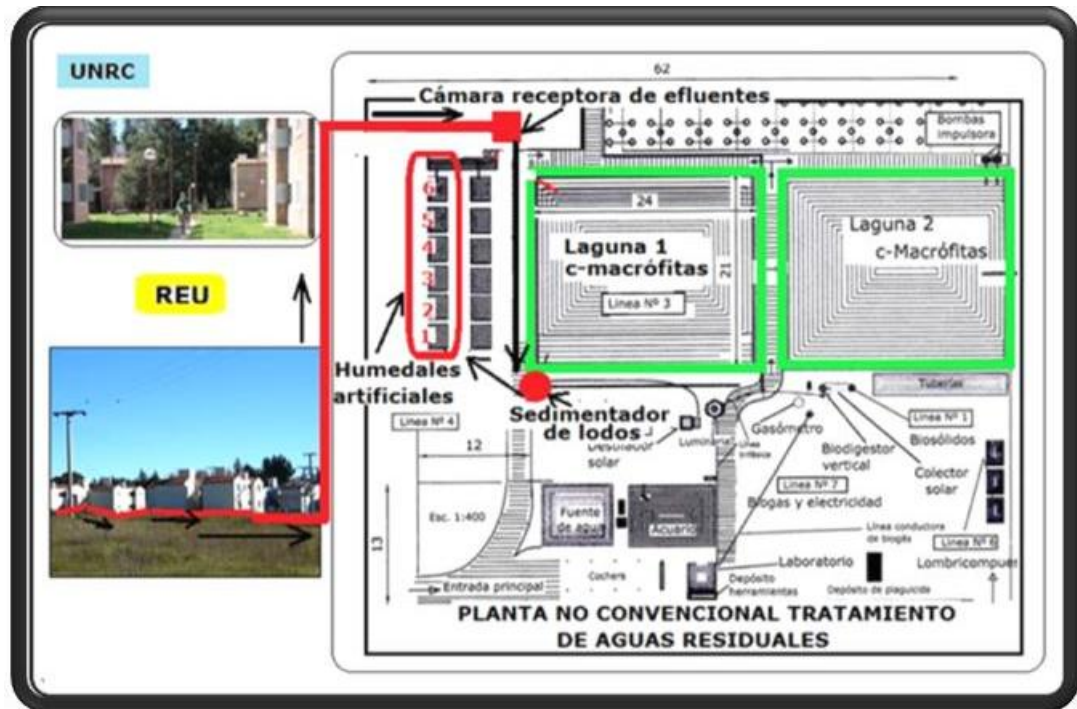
Plano general y ubicación del ensayo. Planta Piloto de Tratamiento y Reutilización de Efluentes Urbanos de la UNRC.
